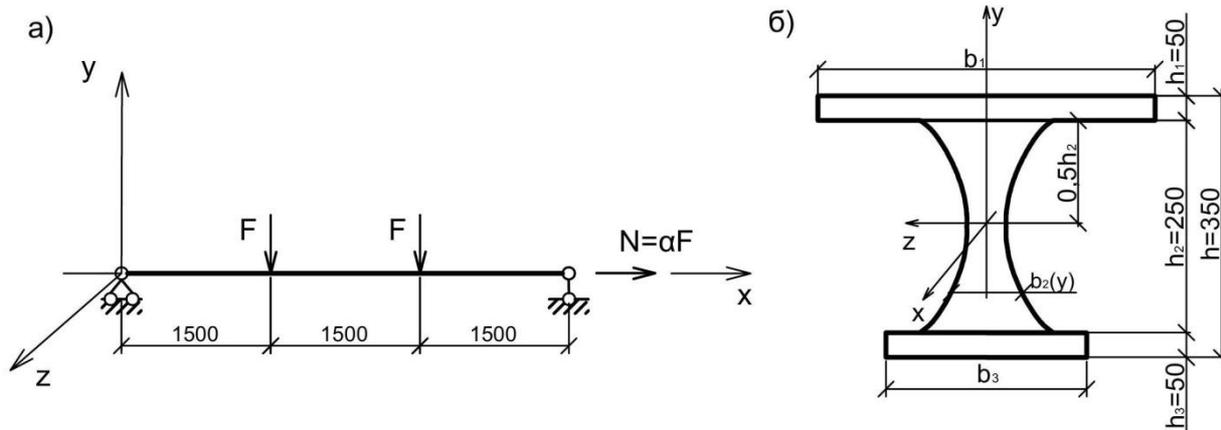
К расчёту деревянной балки: а) расчётная схема балки; б) поперечное сечение балки
